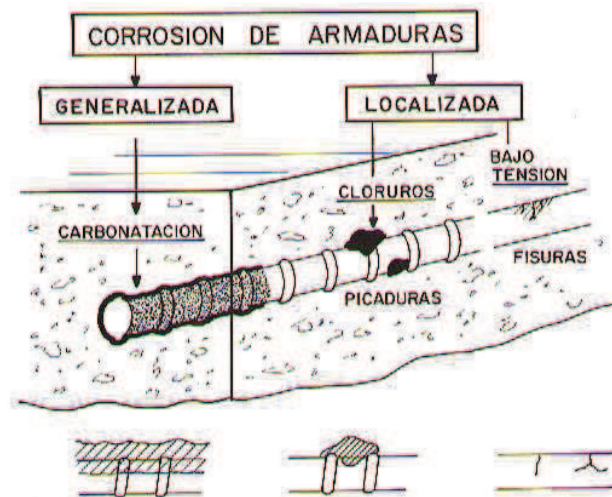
Tipos de corrosión de las armaduras en el hormigón. Tomado de (Feliu et al., [28]).
